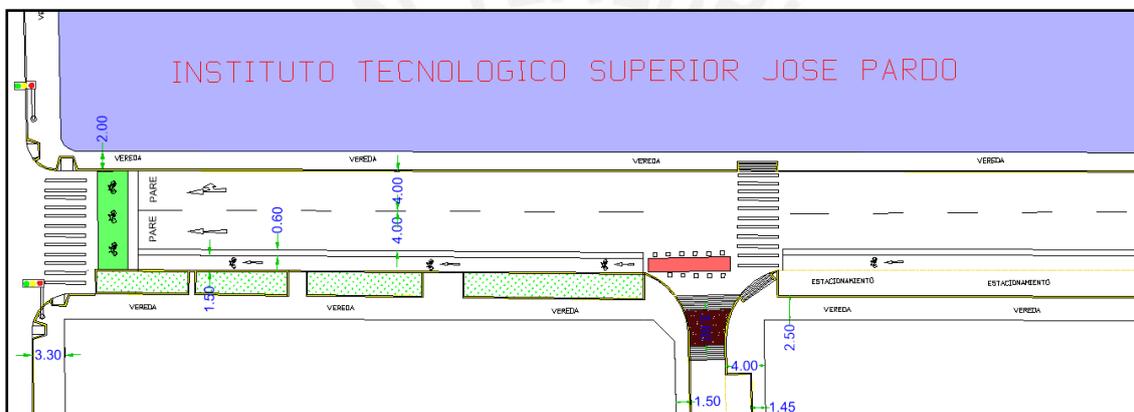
Vista en planta de situación propuesta en Av. Andahuaylas
